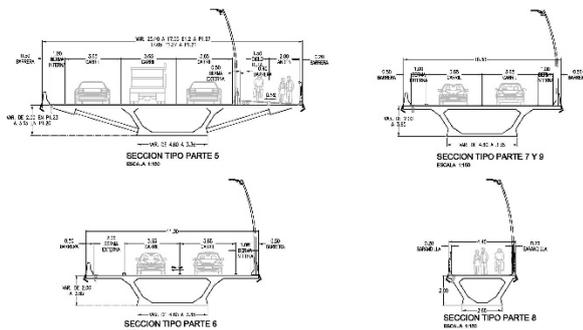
Secciones tipo de los tableros de los distintos ramales.
